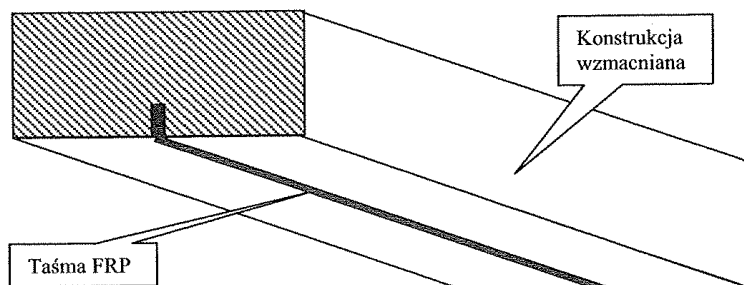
Możliwe miejsca doklejenia taśm FRP w różnych konstrukcjach betonowych
